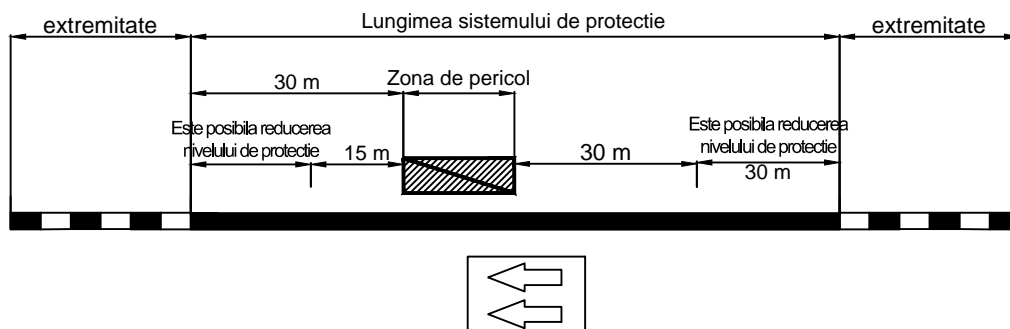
Lungimi minime ale parapetelor de siguranta la drumuri cu doua benzi pe sens
